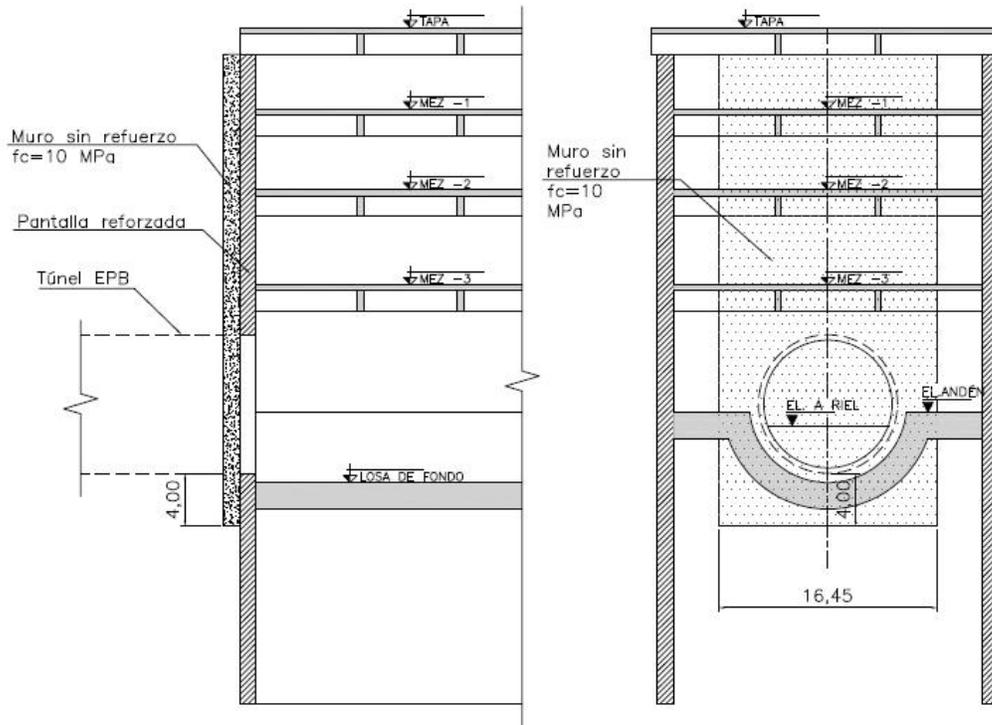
Muro a las entradas y salida de las estaciones (perfil y sección)
